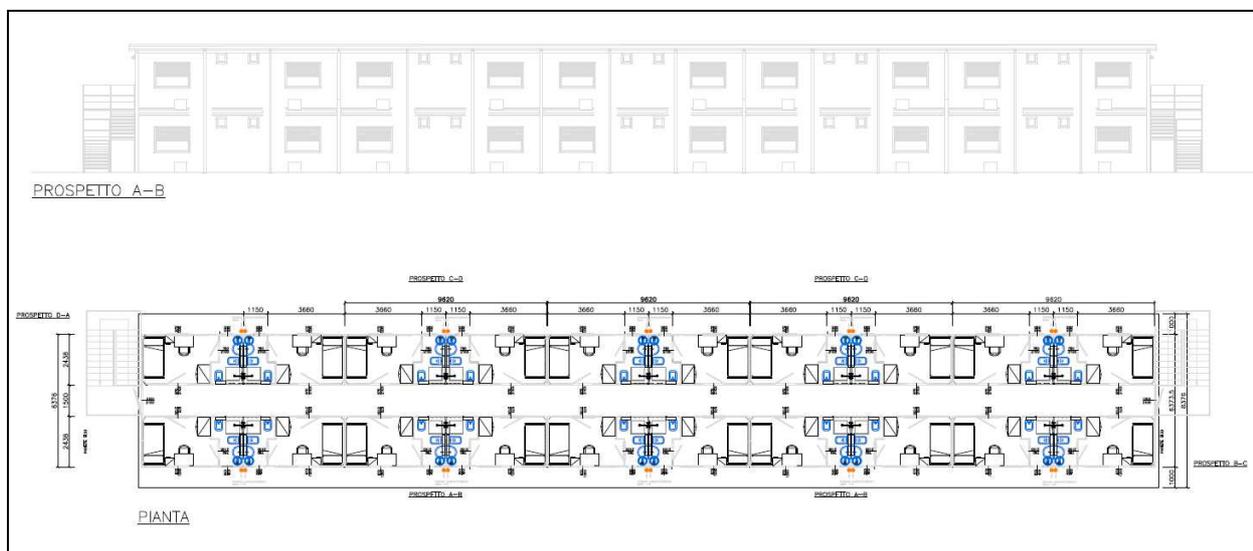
Prospetto e pianta prefabbricato ad uso dormitorio
